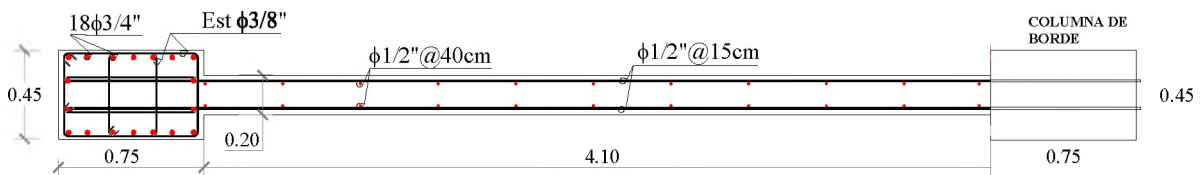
Muro de corte de concreto armado en el edificio de ocho niveles.
